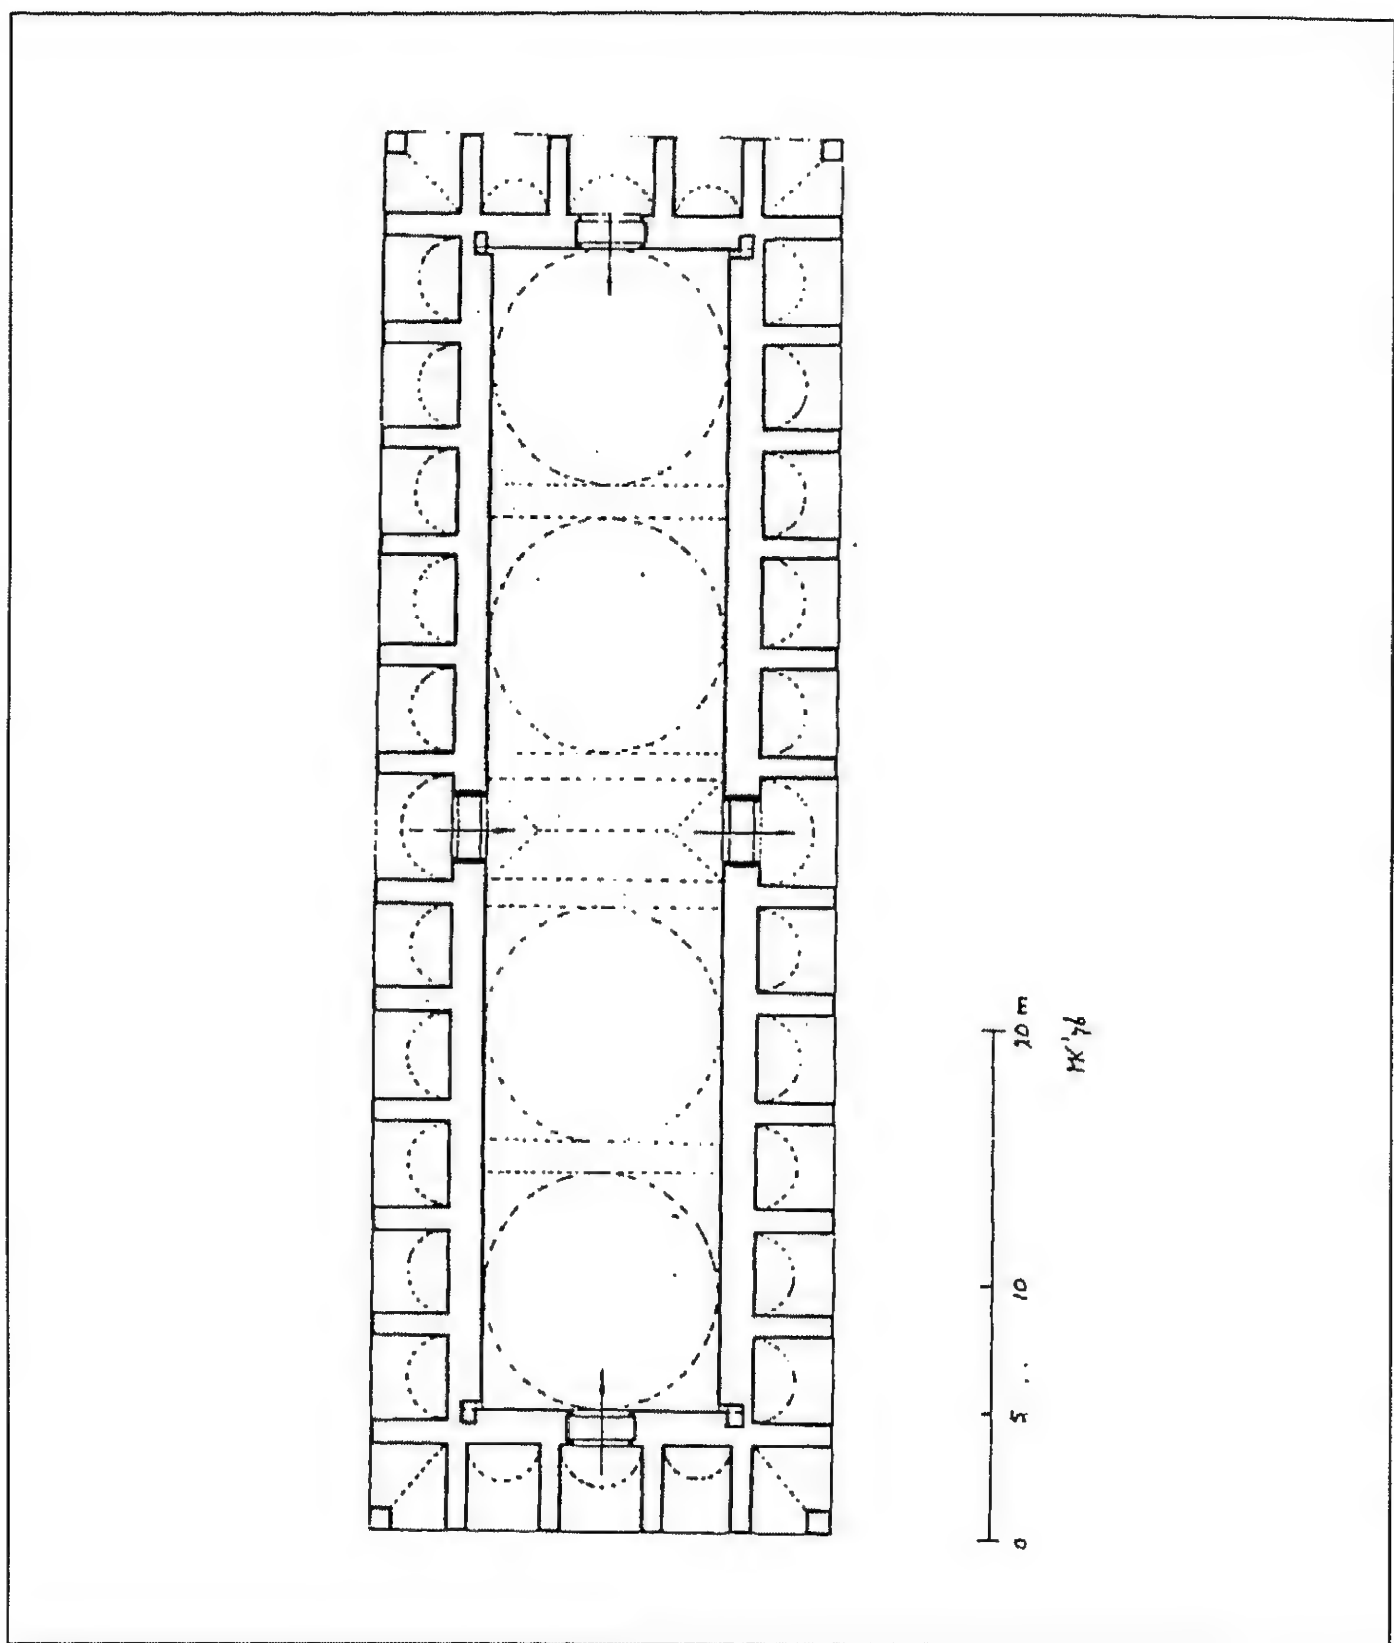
مسقط أفقي لبادستان سيريز باليونان (عن: Cezar).
